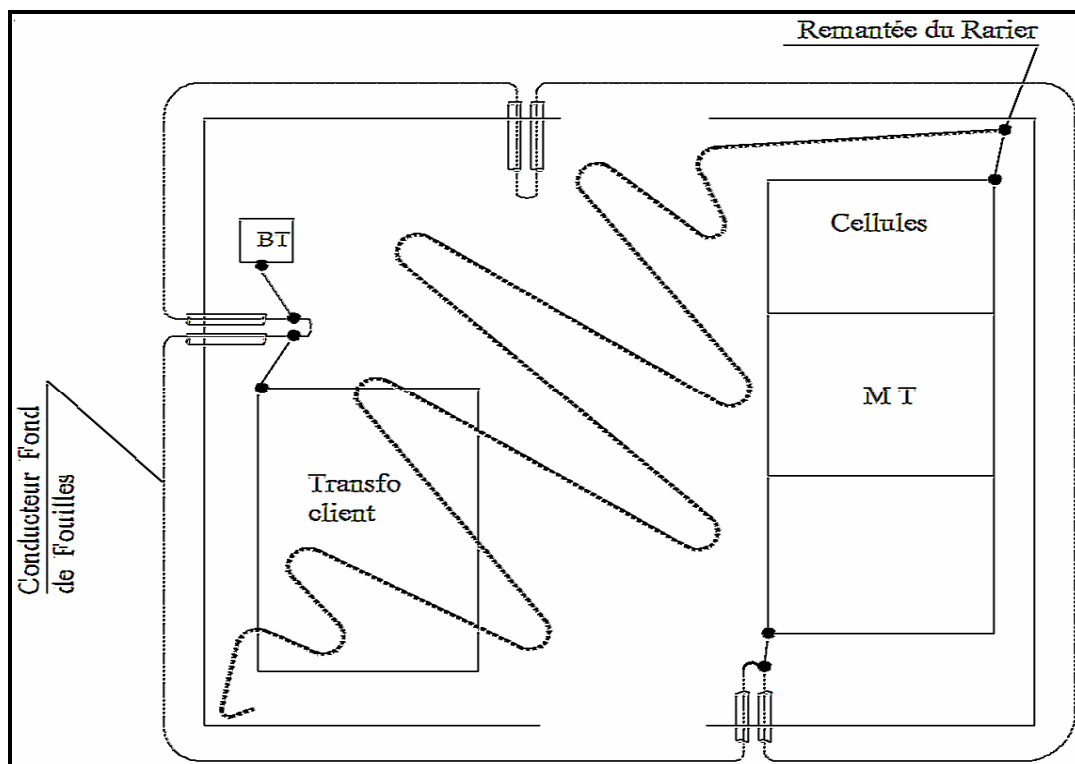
plan de prise de terre d'un poste livraison à comptage BT
